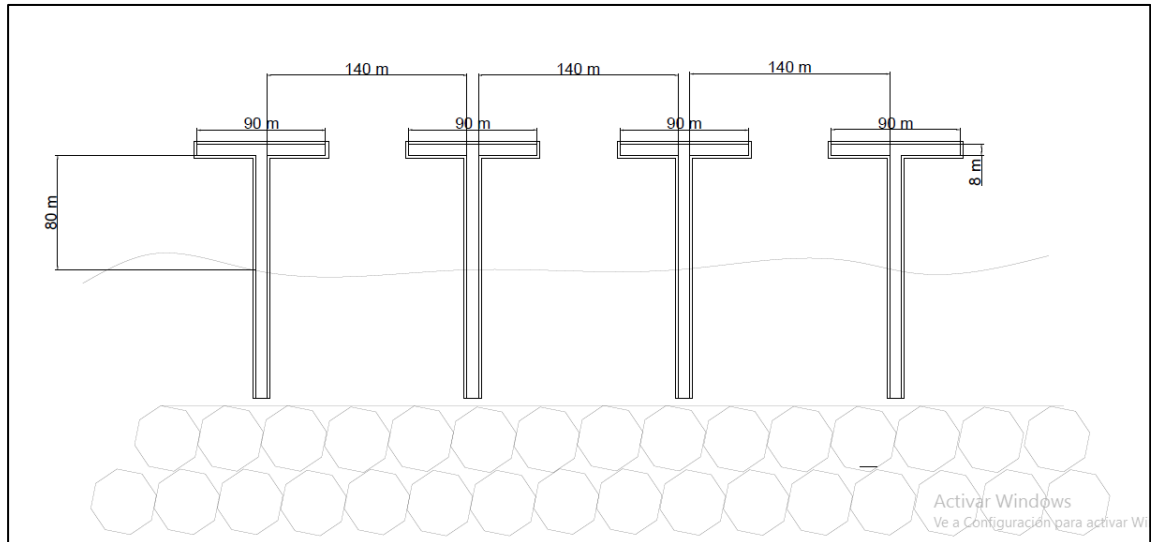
Diseño de espigones en T: Dimensiones [Autores, 2020].
